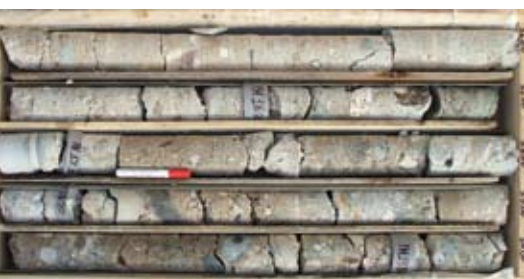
Campioni prelevati con carotiere T6S con diametro da 101 mm
